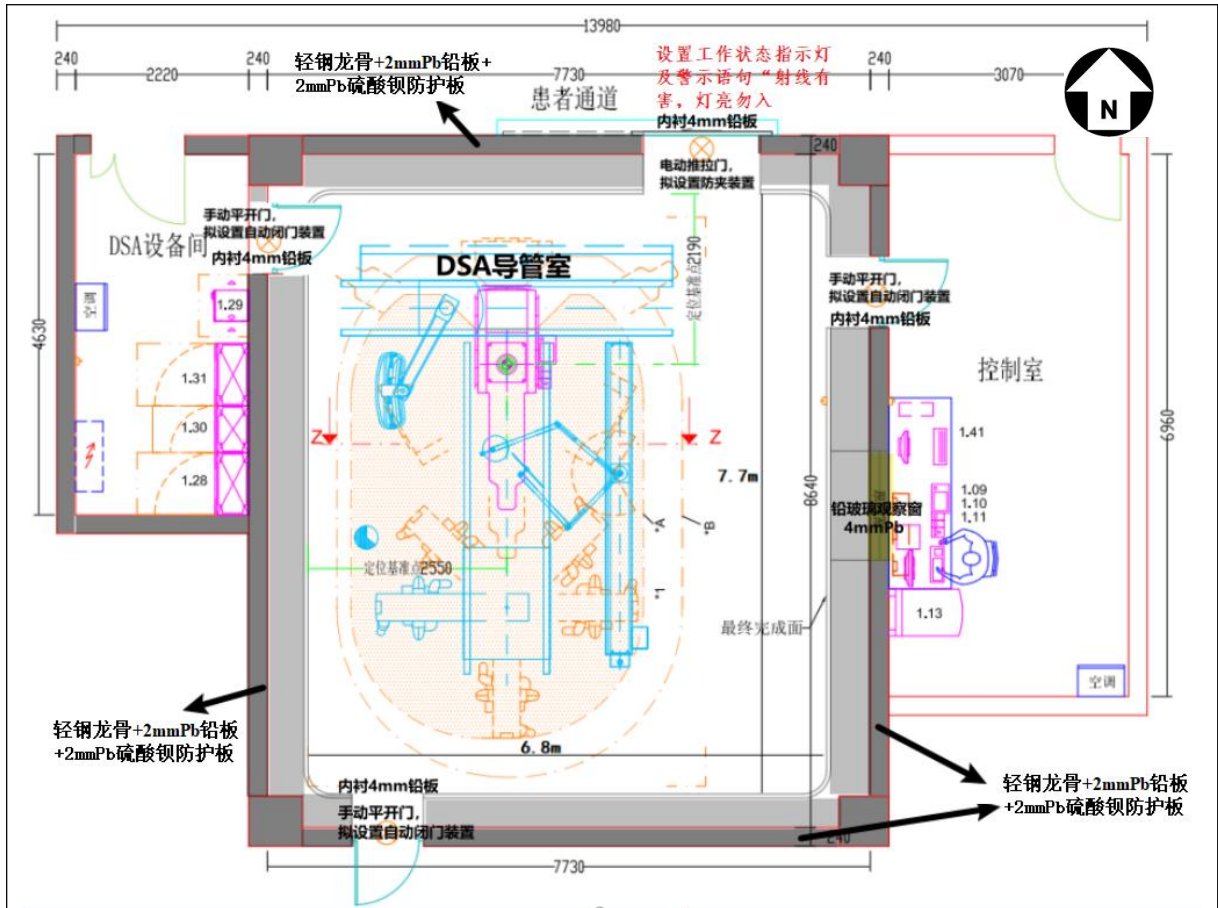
DSA 导管室屏蔽防护设施平面标注示意图
